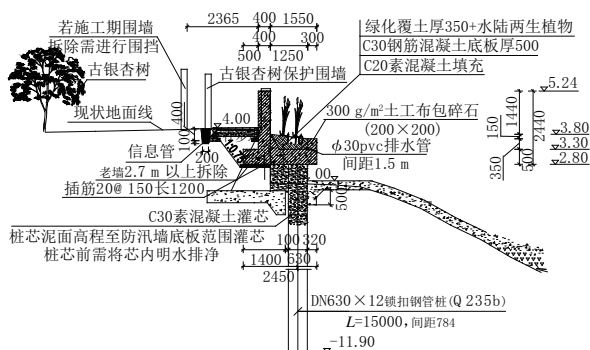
防汛墙维修加固断面(尺寸单位:mm;高程单位:m)
